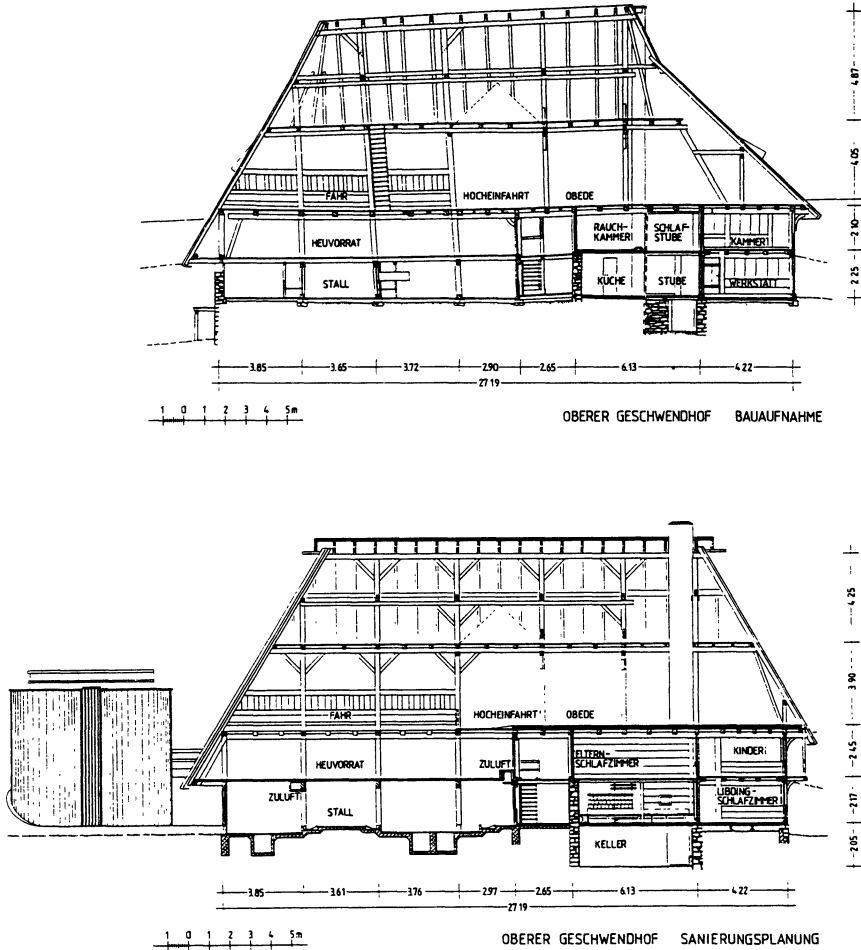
Oberer Geschwendhof, Längsschnitt; oben: Bauaufnahme, unten: Sanierungsplanung.
